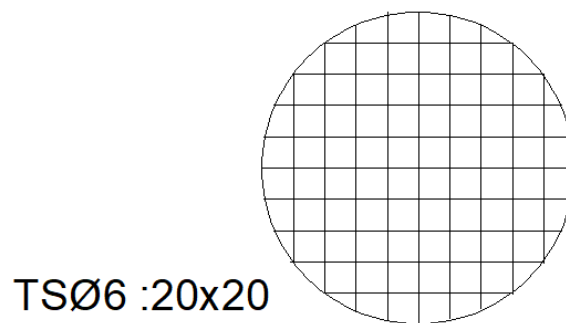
Schéma de ferrailage de la dalle de compression
